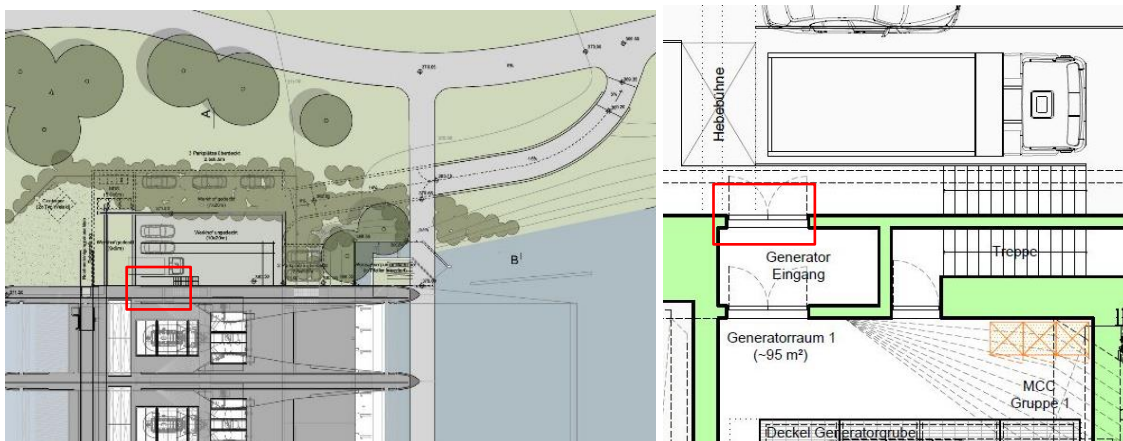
Prüfungswerte Wiederverwendung der alten Holztore beim Generatoren-Eingang (zugänglich vom Werkhof). Situation aus Plan Nr. 133_201 B (links); Zentrale KW Aarau Grundrisse 2-2 (366.92 M ü.M.) Plan Nr. Eniwa: P.33.987 (rechts).
